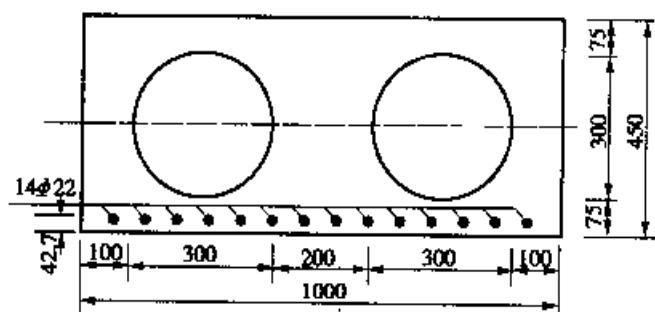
钢筋混凝土宽心板的配筋 (尺寸单位: mm)
